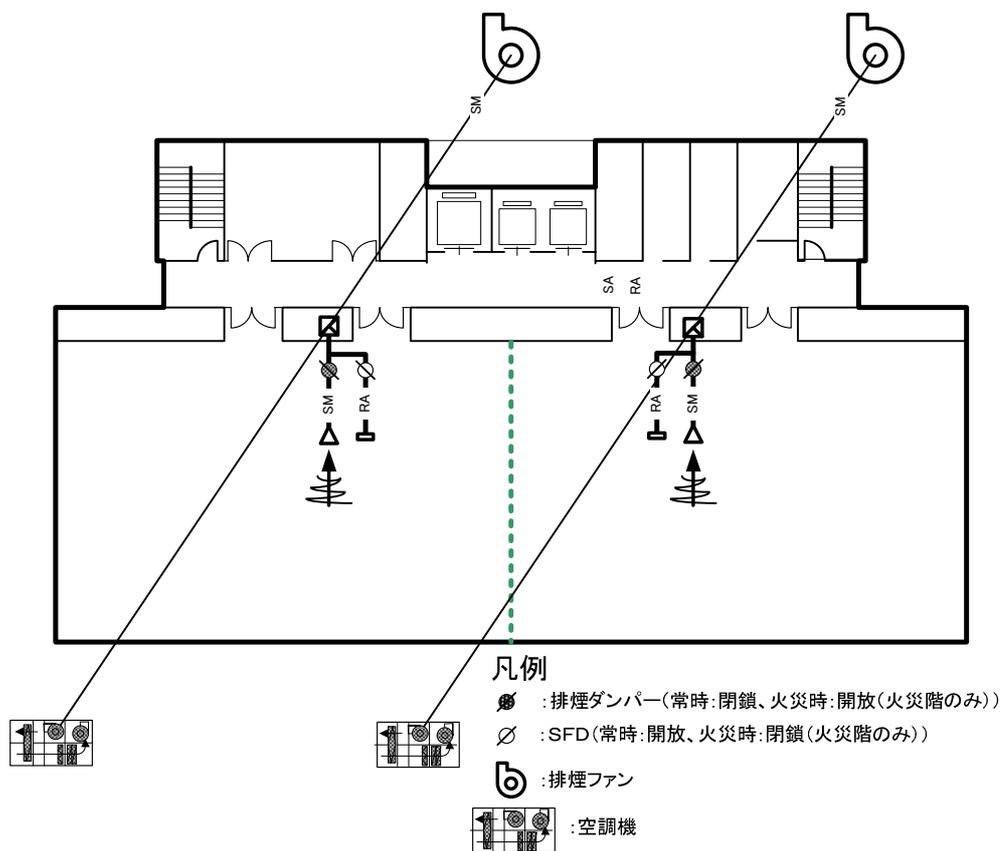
空調兼用排煙システムの平面図（図 4.13 の例に対応）
